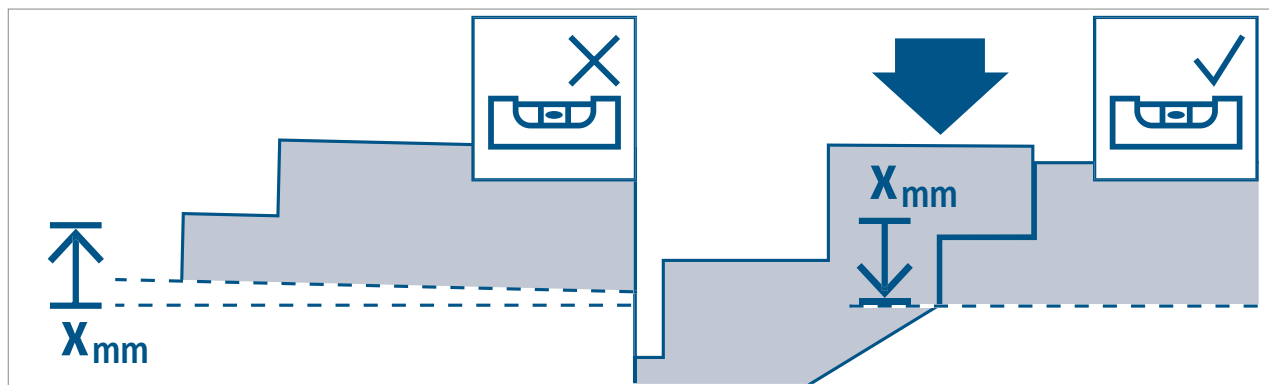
Schöck Tronsole® Typ P: Überhöhung gemäss Werkplan
